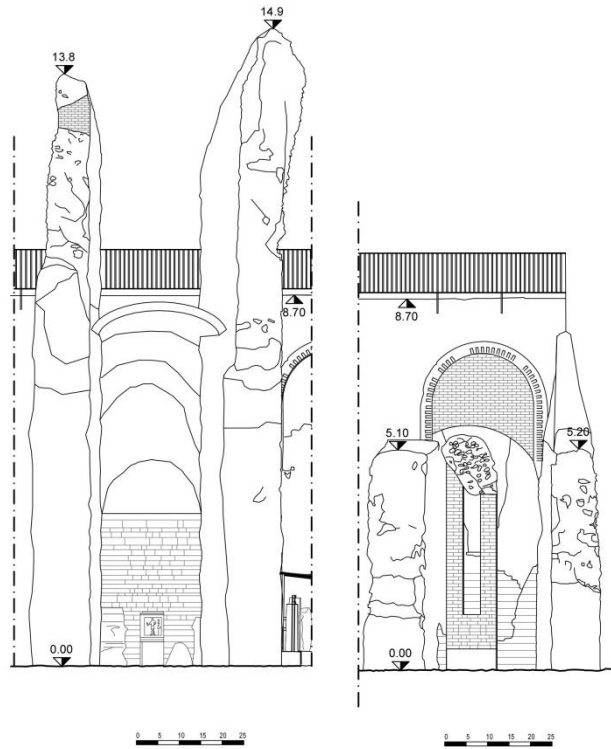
Prospetto a valle del setto A1-A2, A3-A4
